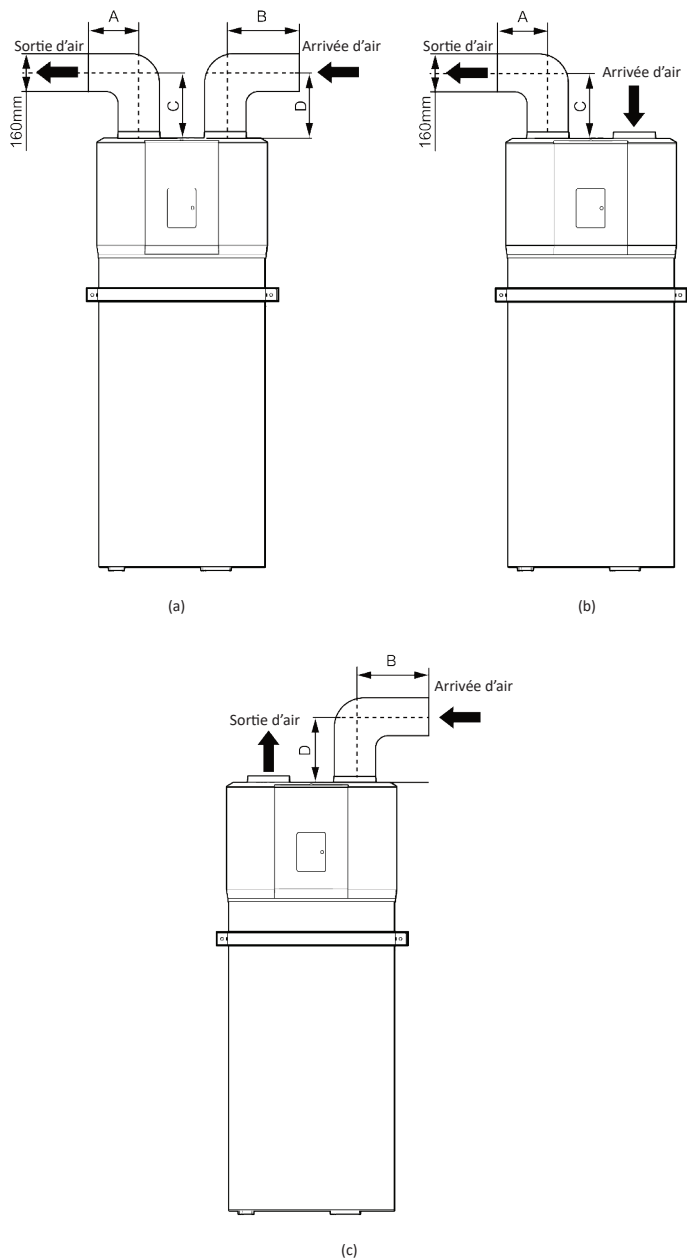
Schémas d'installation des conduits d'entrée et de sortie d'air
